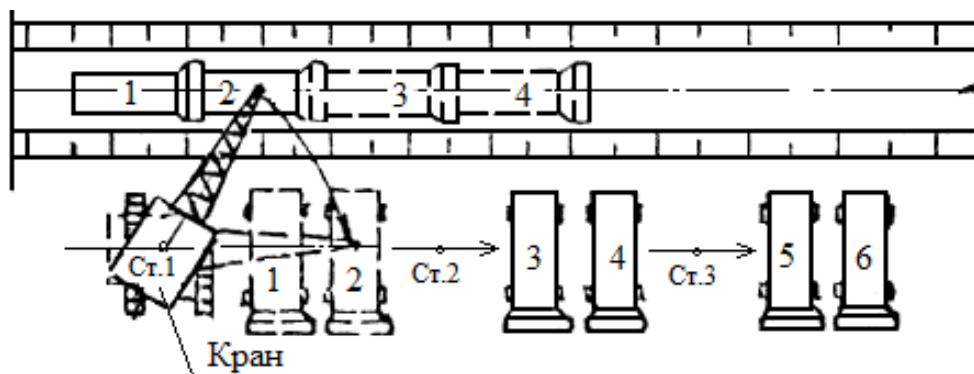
Раскладка раструбных труб перпендикулярно оси траншеи с укладкой краном с одной стоянки двух труб
